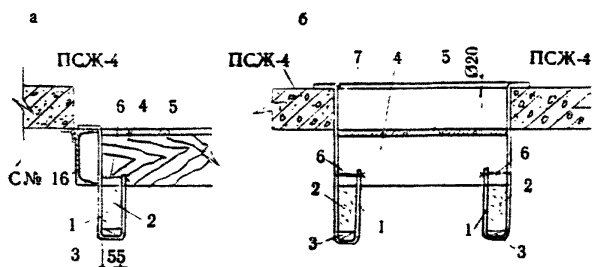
Опираие металлических крюков на металлические балки (а) и железобетонные плиты (б); 1 - металлические крюки; 2 - деревянный прогон 50x150 мм; 3 - клиновидный упор; 4 - деревянная балка 50x150 мм; 5 - опалубочный настил из досок $\delta = 25$ мм; 6 - проволоочная скрутка; 7 - распорный металлический прут $\delta 20$ мм, соединенный на сварке с опорной частью крюков (1)
